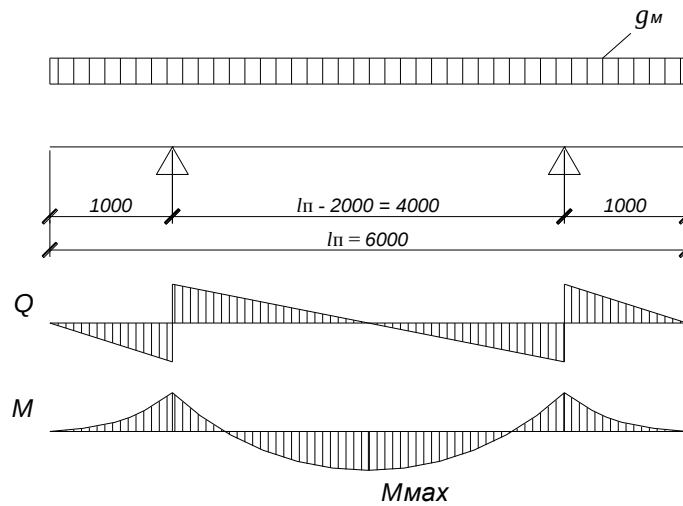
Розрахункова схема стінової панелі при розрахунку на монтажне навантаження
